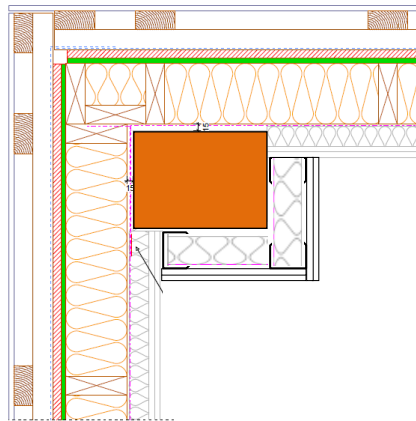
Plans de repérage des éléments apparents et des encoffrements,
